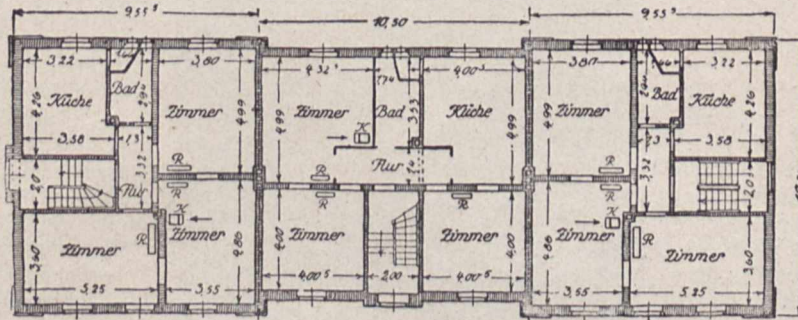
Mehrfamilienhaus mit Stockwerksheizungen. Grundriß des 1. Geschosses im Maßstab 1 : 300. Jede Wohnung enthält drei beheizte Zimmer; der Kessel ist in einem Wohnzimmer aufgestellt.
